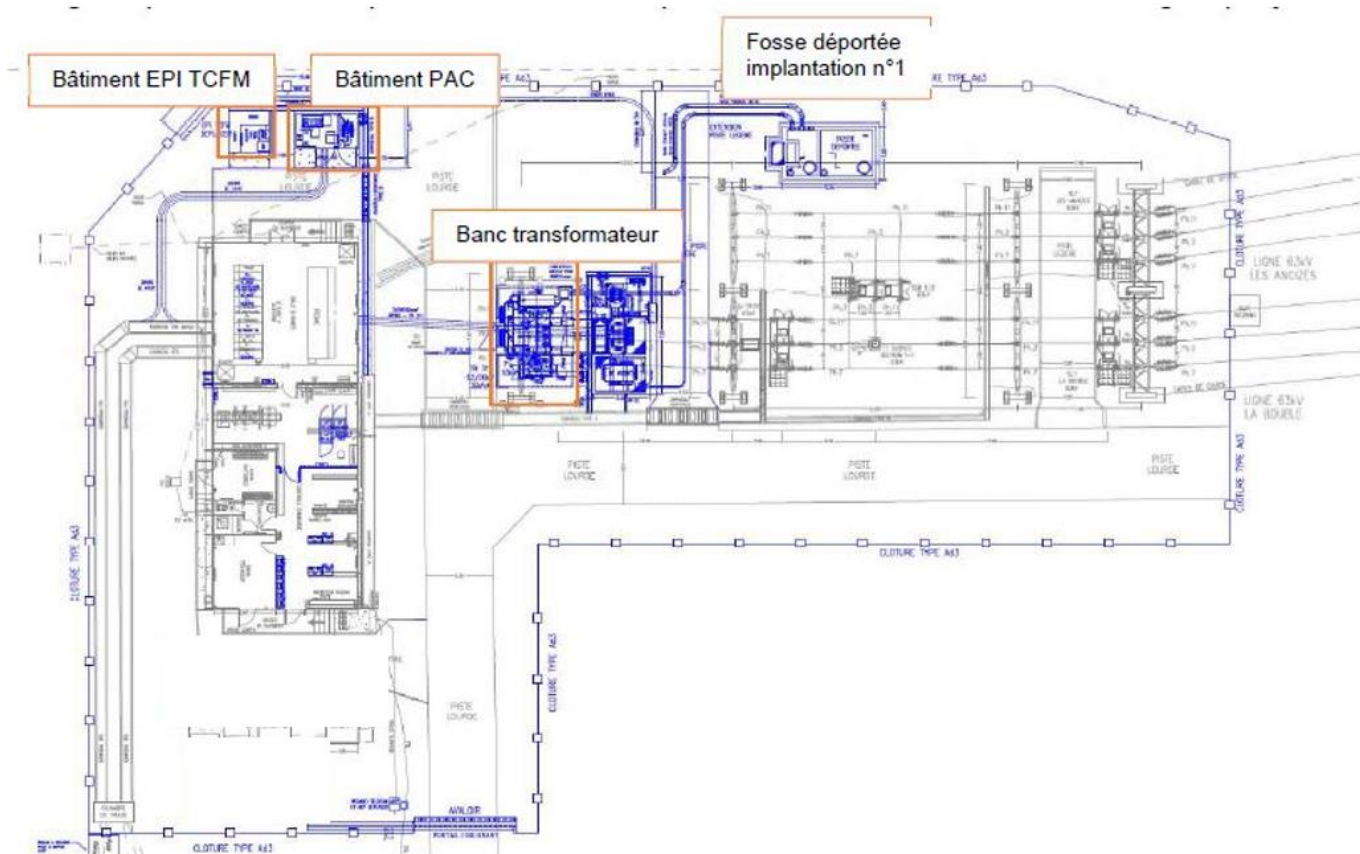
PLAN MASSE DES OUVRAGES PROJETES
